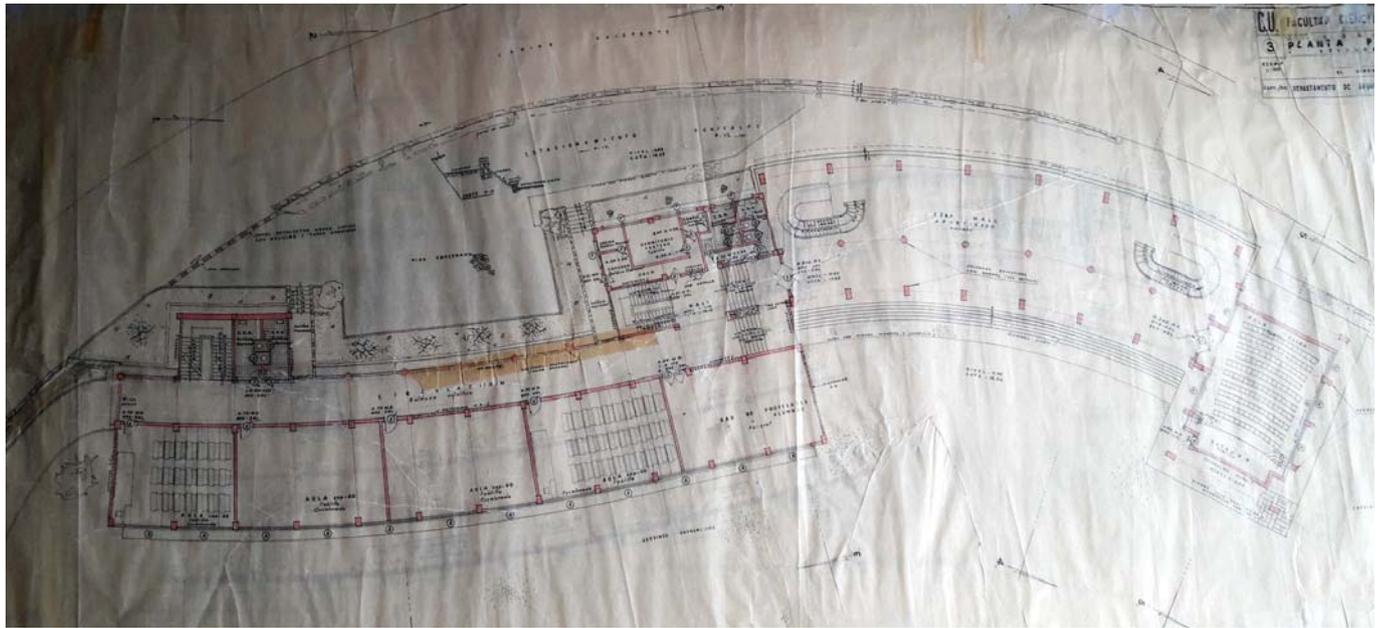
Fotografía de Planta Baja del edificio, se observa planta libre
